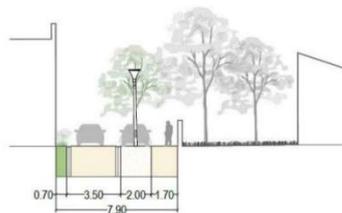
COUPE PROJET AU DROIT DE L'IMPASSE DES ROSIERS
